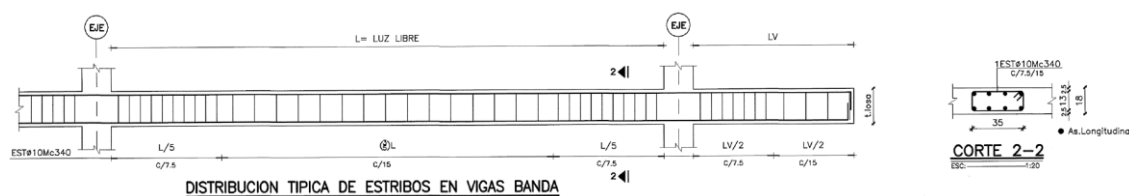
Distribución típica de los estribos en vigas banda
